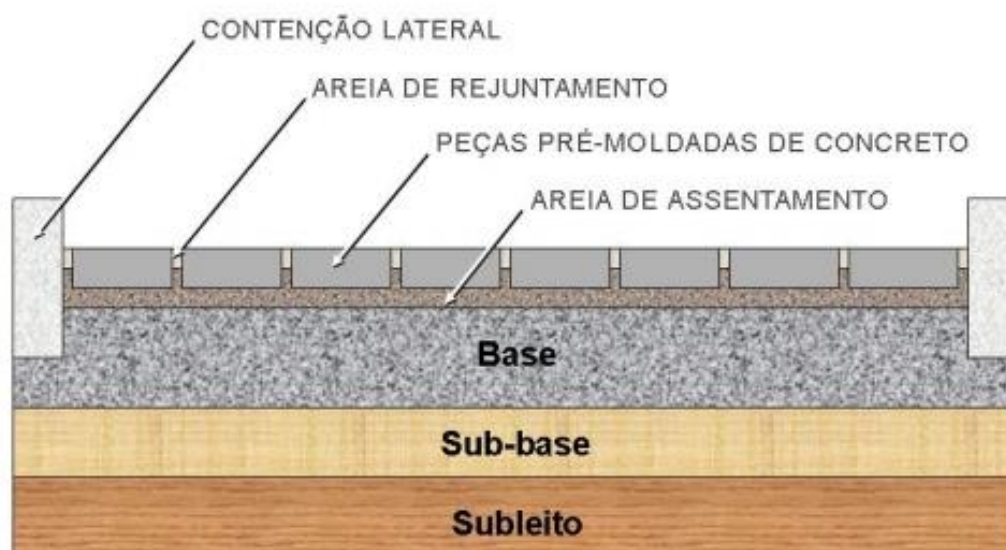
Estrutura típica de um pavimento intertravado (Godinho, 2009).
